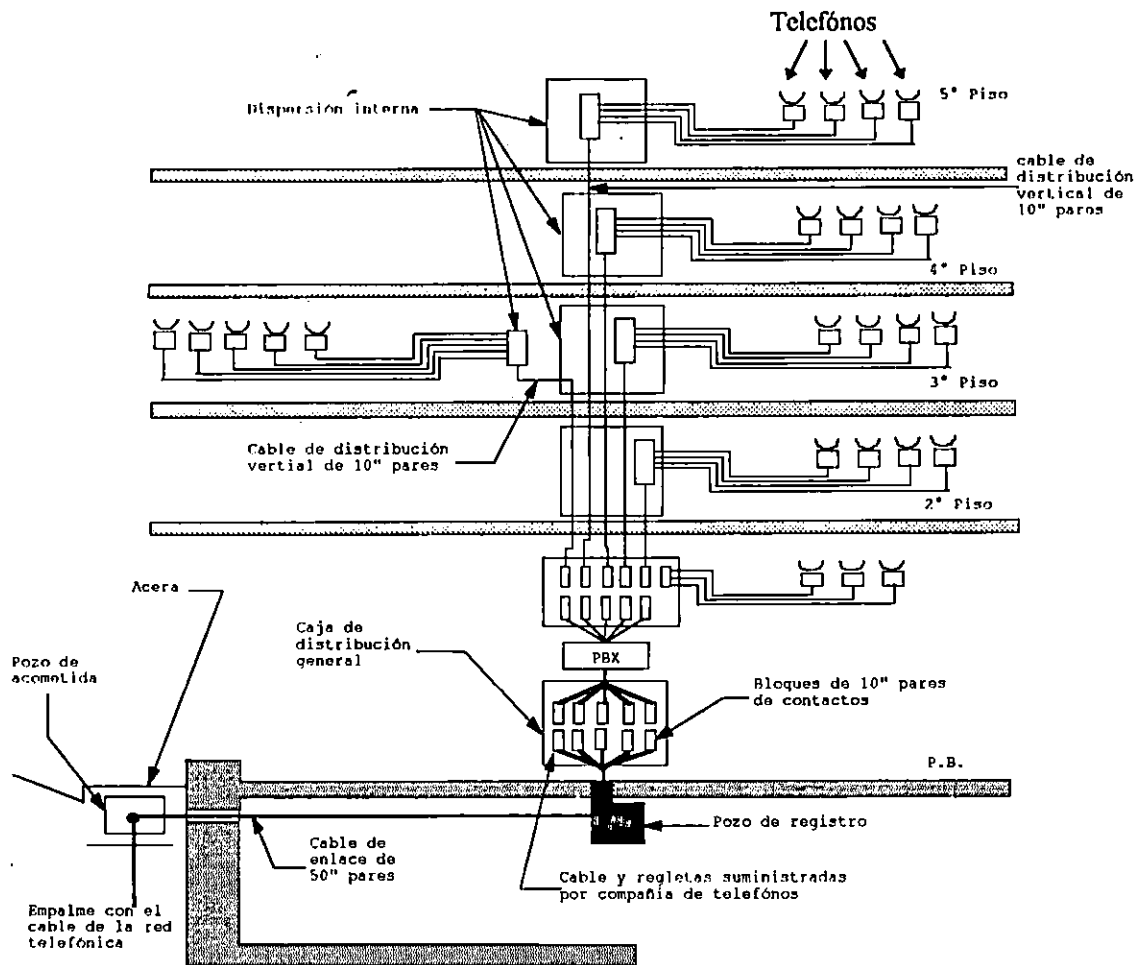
Detalles de la distribución telefónica en un edificio.
